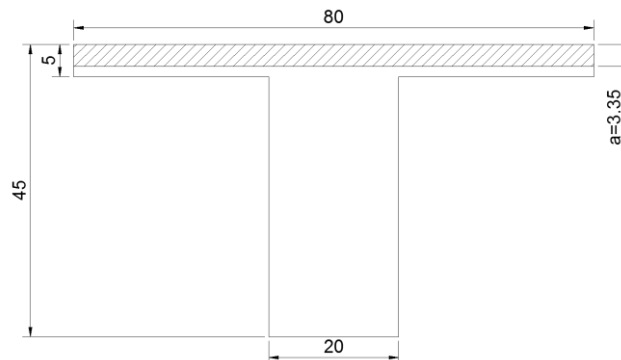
Dimensiones de la nervadura a diseñar, dimensiones en cm.
